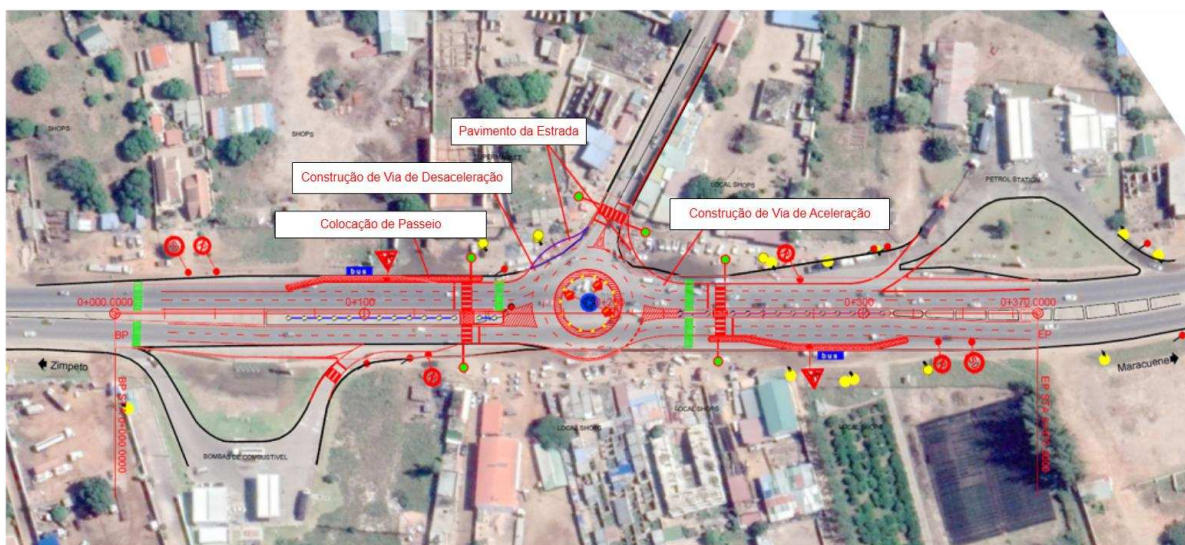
Planta de Implantação do projeto de melhoria da segurança no entroncamento com a R408.
